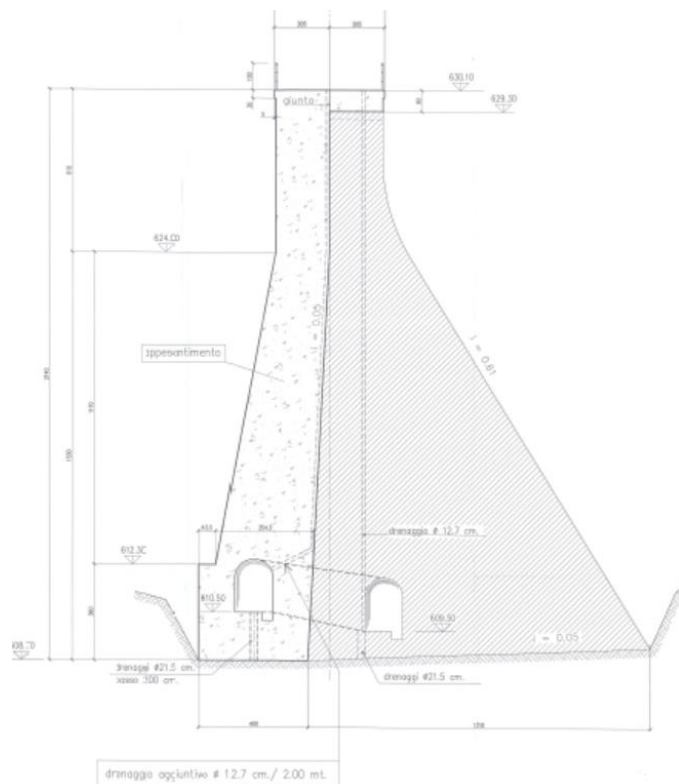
Sezione emergente tratta dal dis. 980.003.733 rev 02 del progetto approvato
